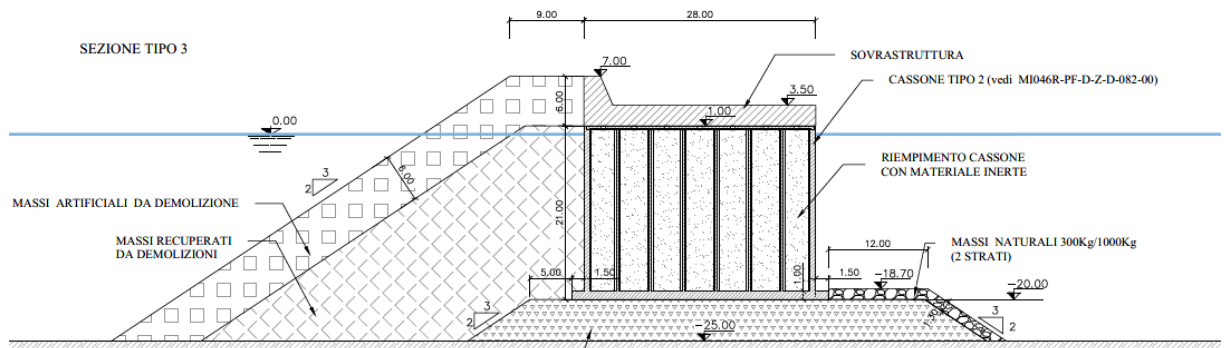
DIGA DI SOPRAFLUTTO - SEZIONE TIPO 3 (FONDALE MEDIO 25 M)
